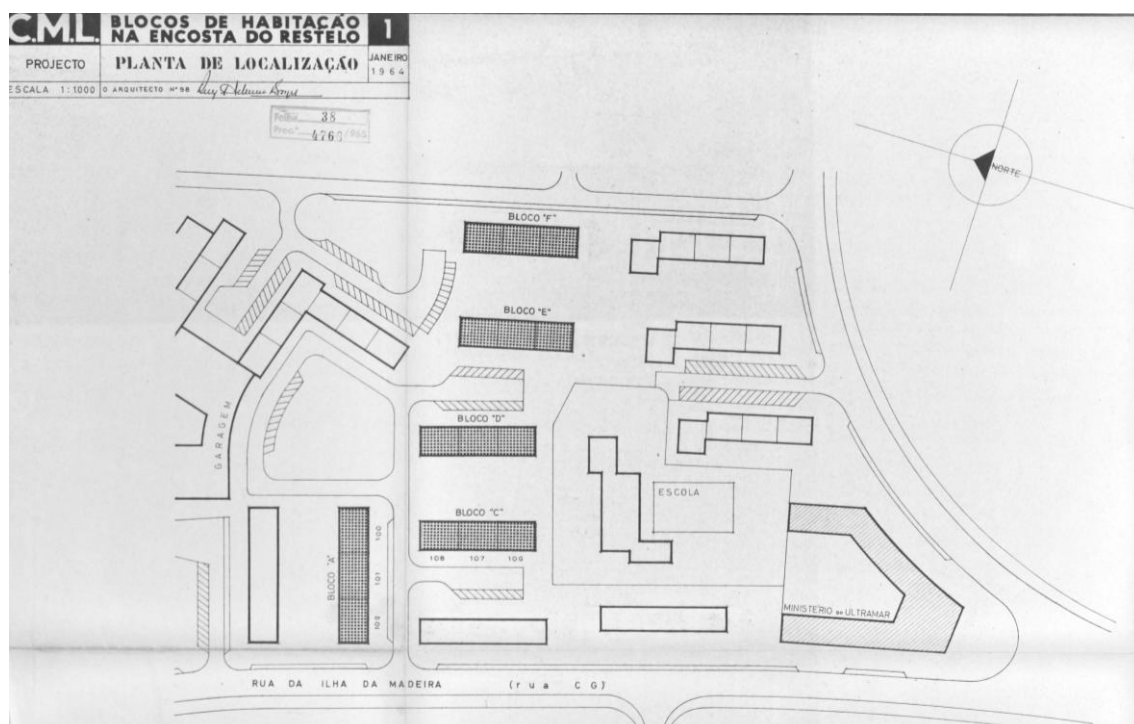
Planta de localização do *Estudo do conjunto arquitectónico e arranjo urbanístico do pormenor do terreno junto à Rua C.G.*, Ruy António da Silveira Borges, 1965⁴²⁰
